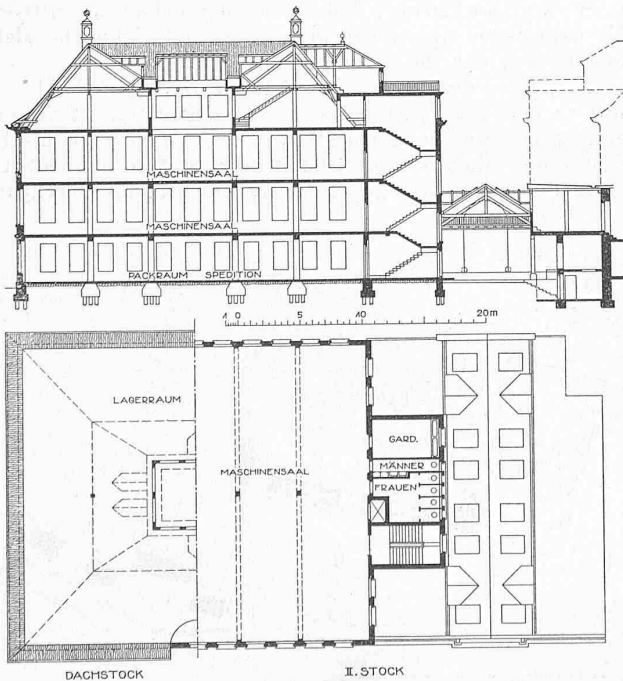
Grundrisse und Schnitt der Fabrik Hochuli & Cie., 1 : 550.
